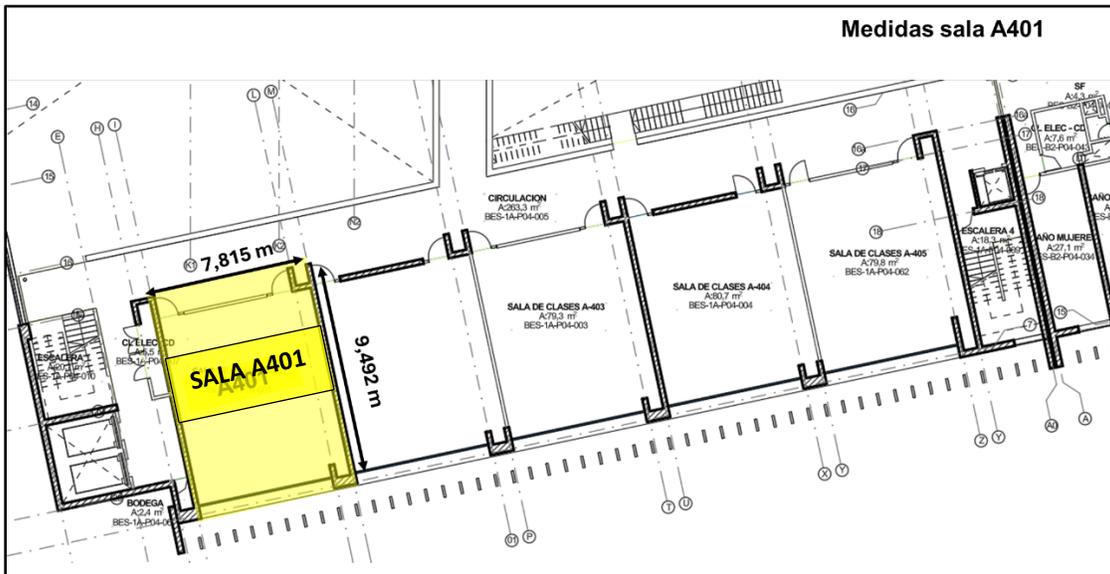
Dimensiones en metros sala A401 Sede Bellavista - AutoCAD
